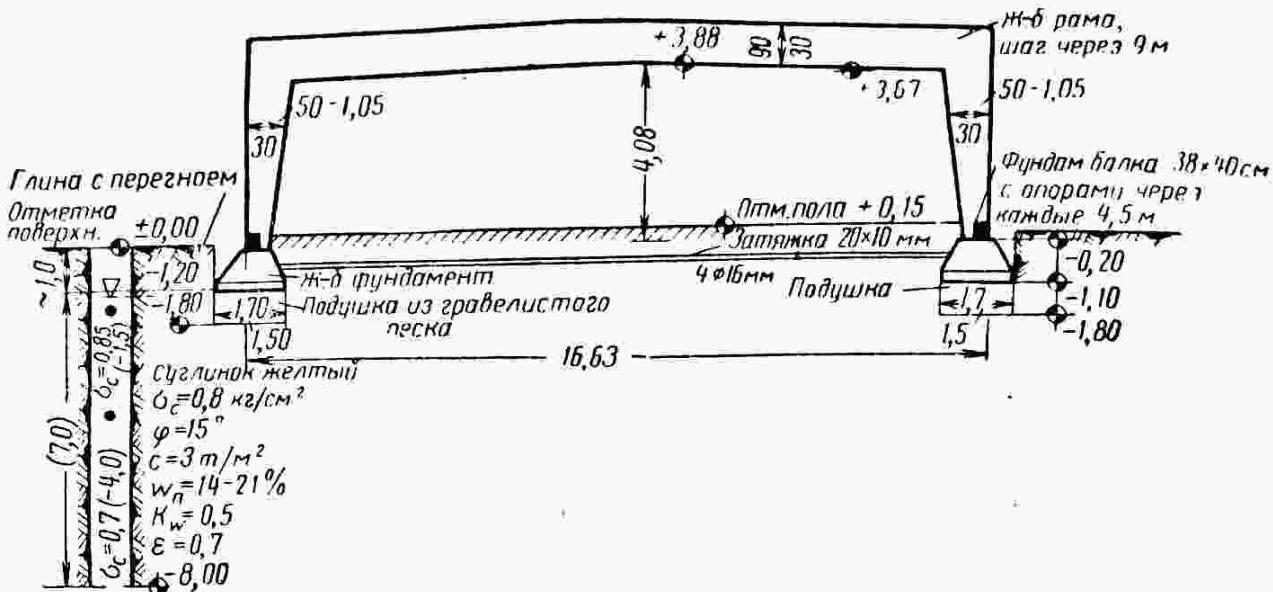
Геологический разрез площадки строительства ремонтной мастерской в Шалготарьине
